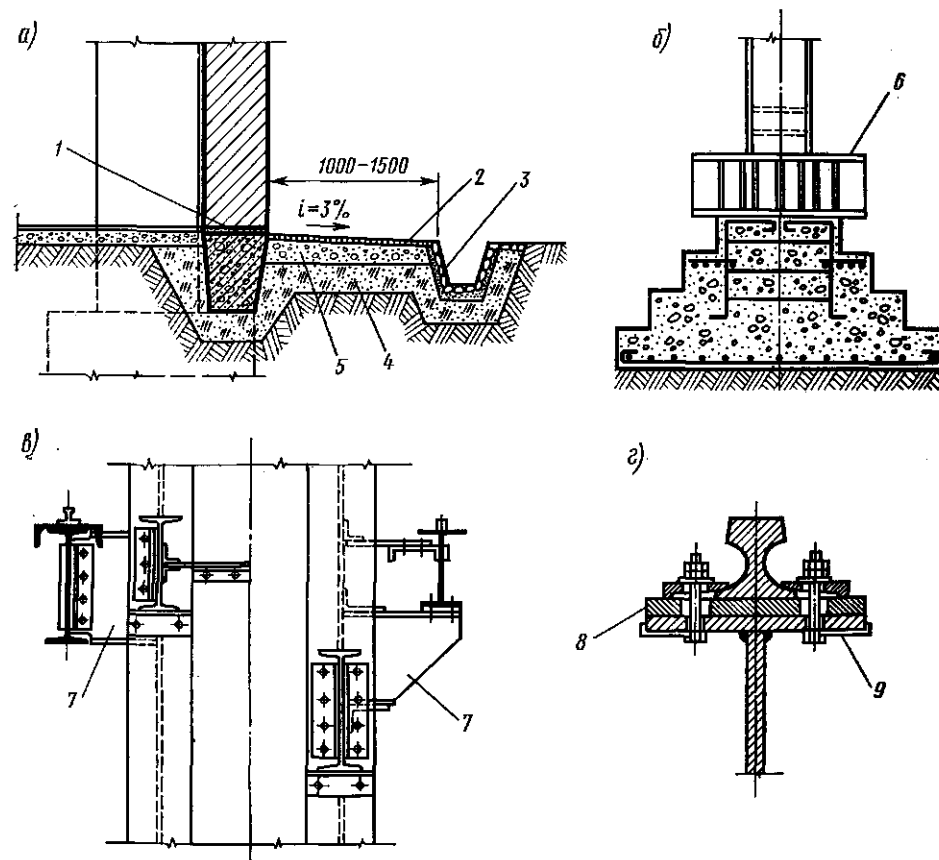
Некоторые конструктивные элементы зданий, возводимых на просадочных грунтах:
